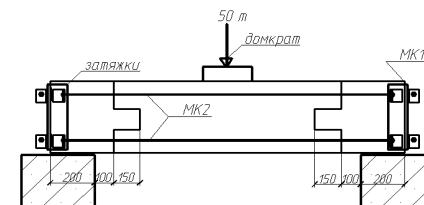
Схема испытания фрагмента сборно-монолитного перекрытия
